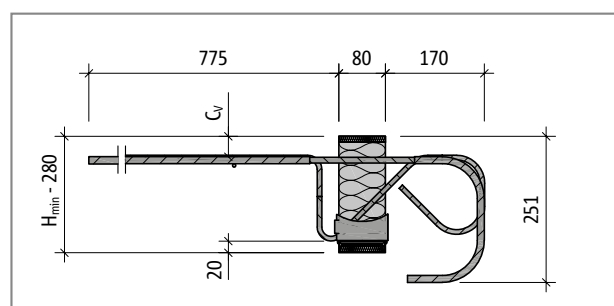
Schöck Isokorb® T tipo KL-O-M8 – KL-O-M12: Sezione dell'elemento
